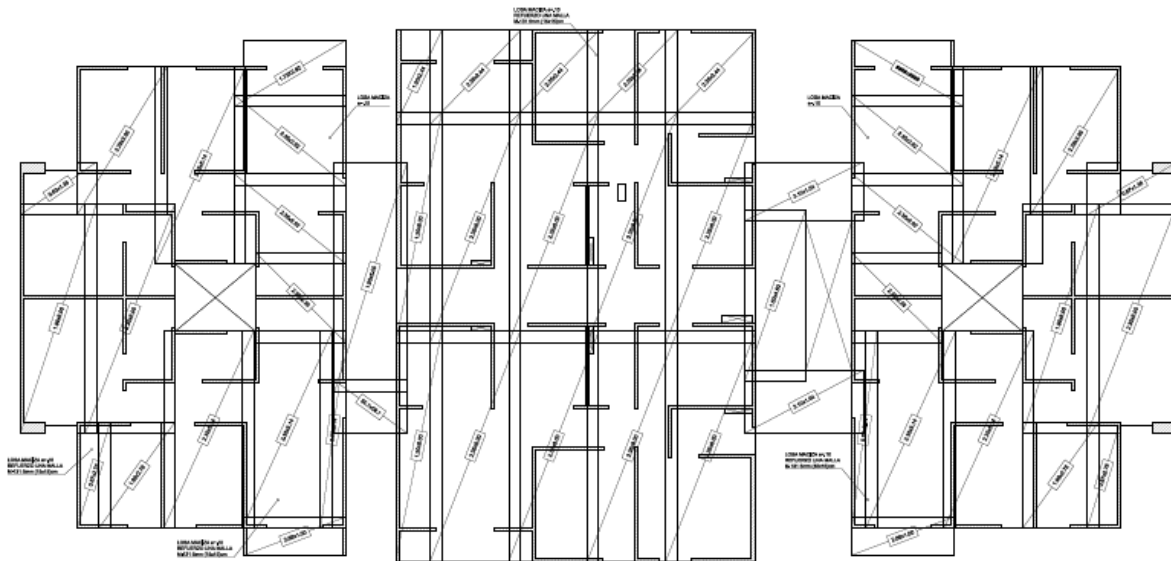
Planta refuerzo convencional en losas con malla electrosoldada. Fuente: Imágenes de planos DUAL INGENIERÍA ESTRUCTURAL SAS. Archivo personal, recuperado en el 2017.
